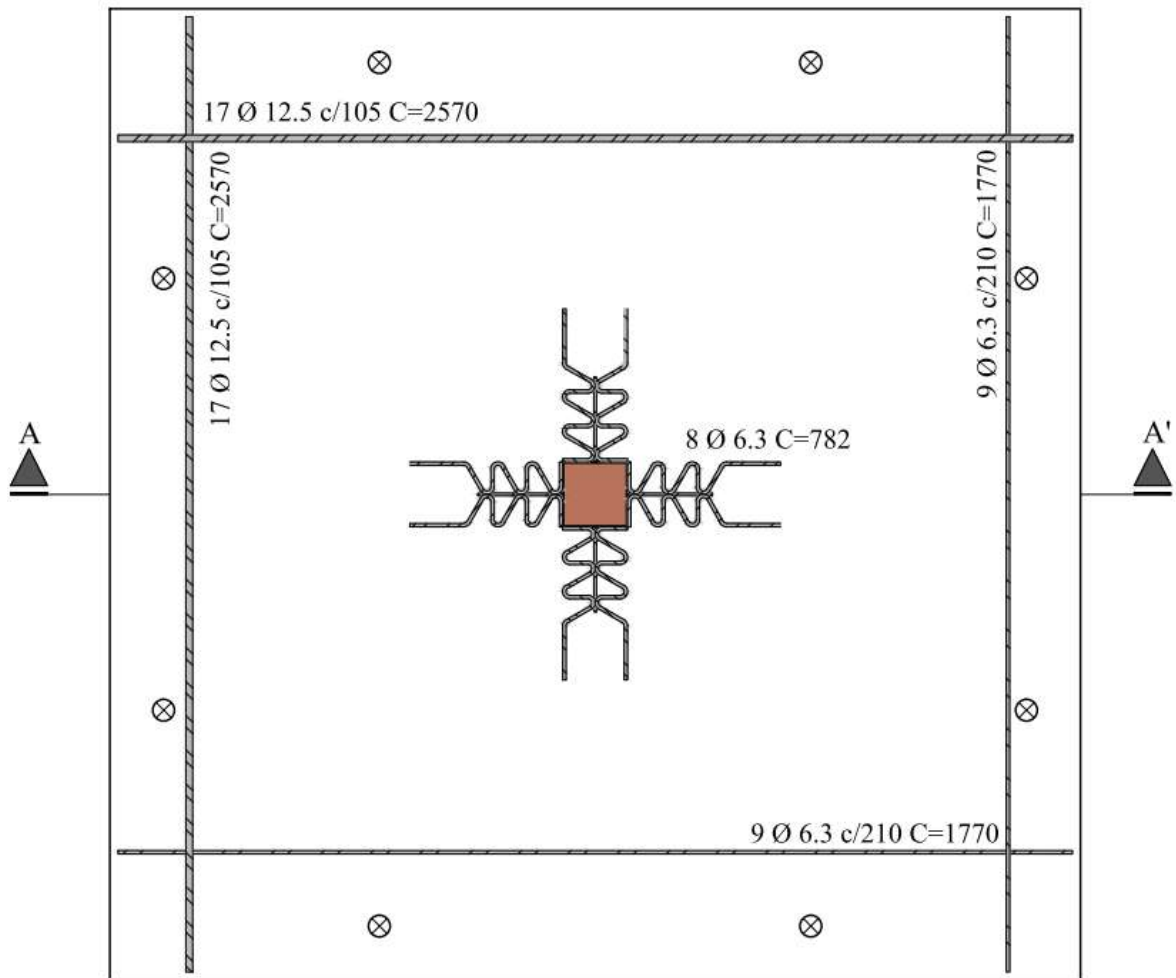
Arranjo das armaduras transversais na laje L1
